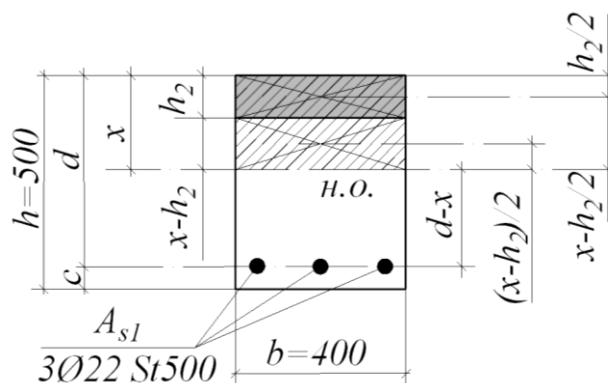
Высота сжатой зоны бетона x . Положение центров тяжести монолитного слоя бетона и сжатой зоны сборного элемента относительно нейтральной оси
